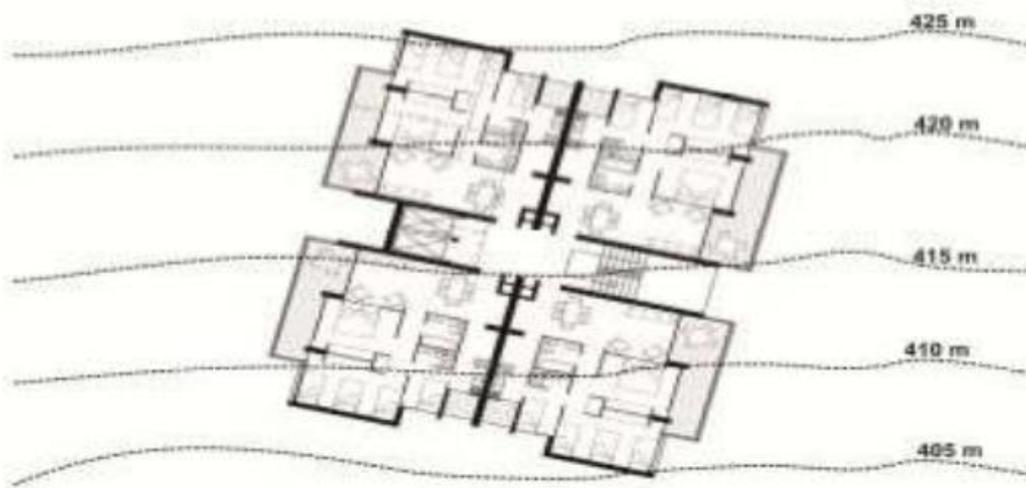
Arquitectura inicial: Planta típica de un edificio con 4 departamentos en la misma planta
